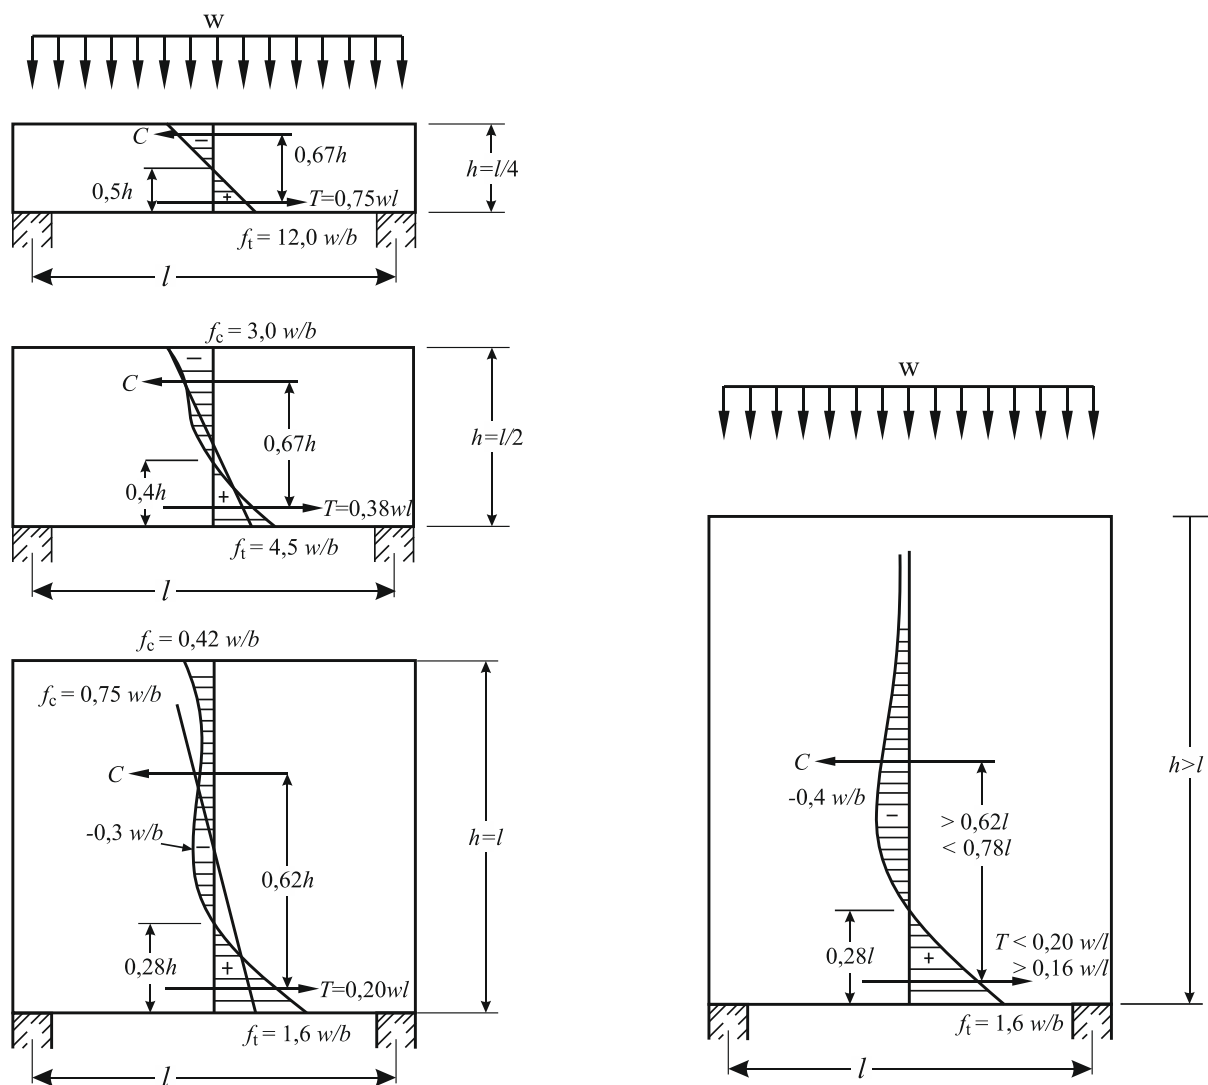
Эпюры нормальных напряжений в вертикальных сечениях армированных балок и балок-стенок [11]
